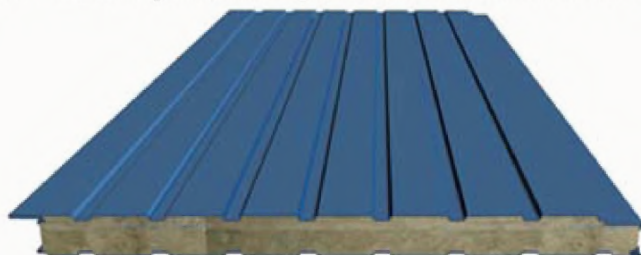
Панель трехслойная стеновая со скрытым креплением
